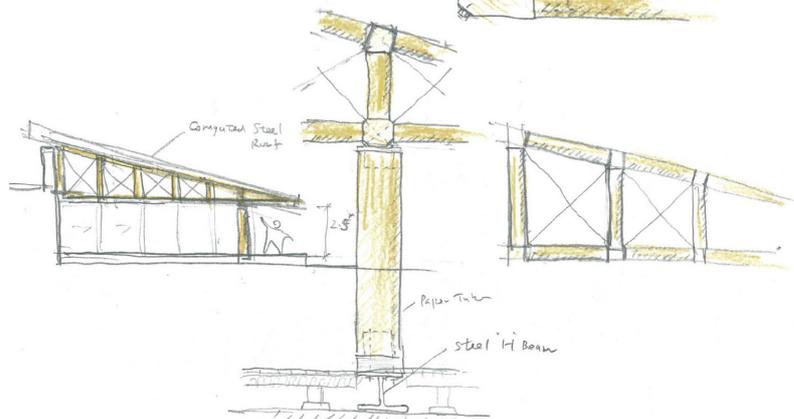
Sección vertical de apoyo de las cerchas de cubierta en pilares.
